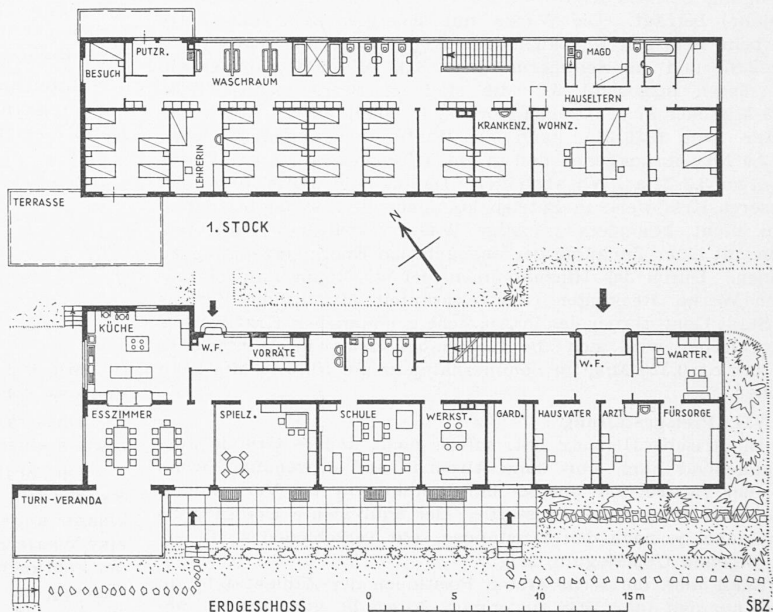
Grundrisse 1 : 400 der Beobachtungs- und Heilanstalt Biberist
